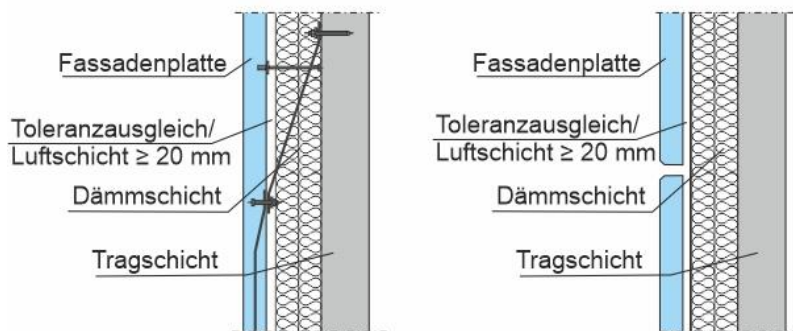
Prinzipielle Fassadenausbildungen und typisches Fugendetail für vorgehängte Fassadenplatten
